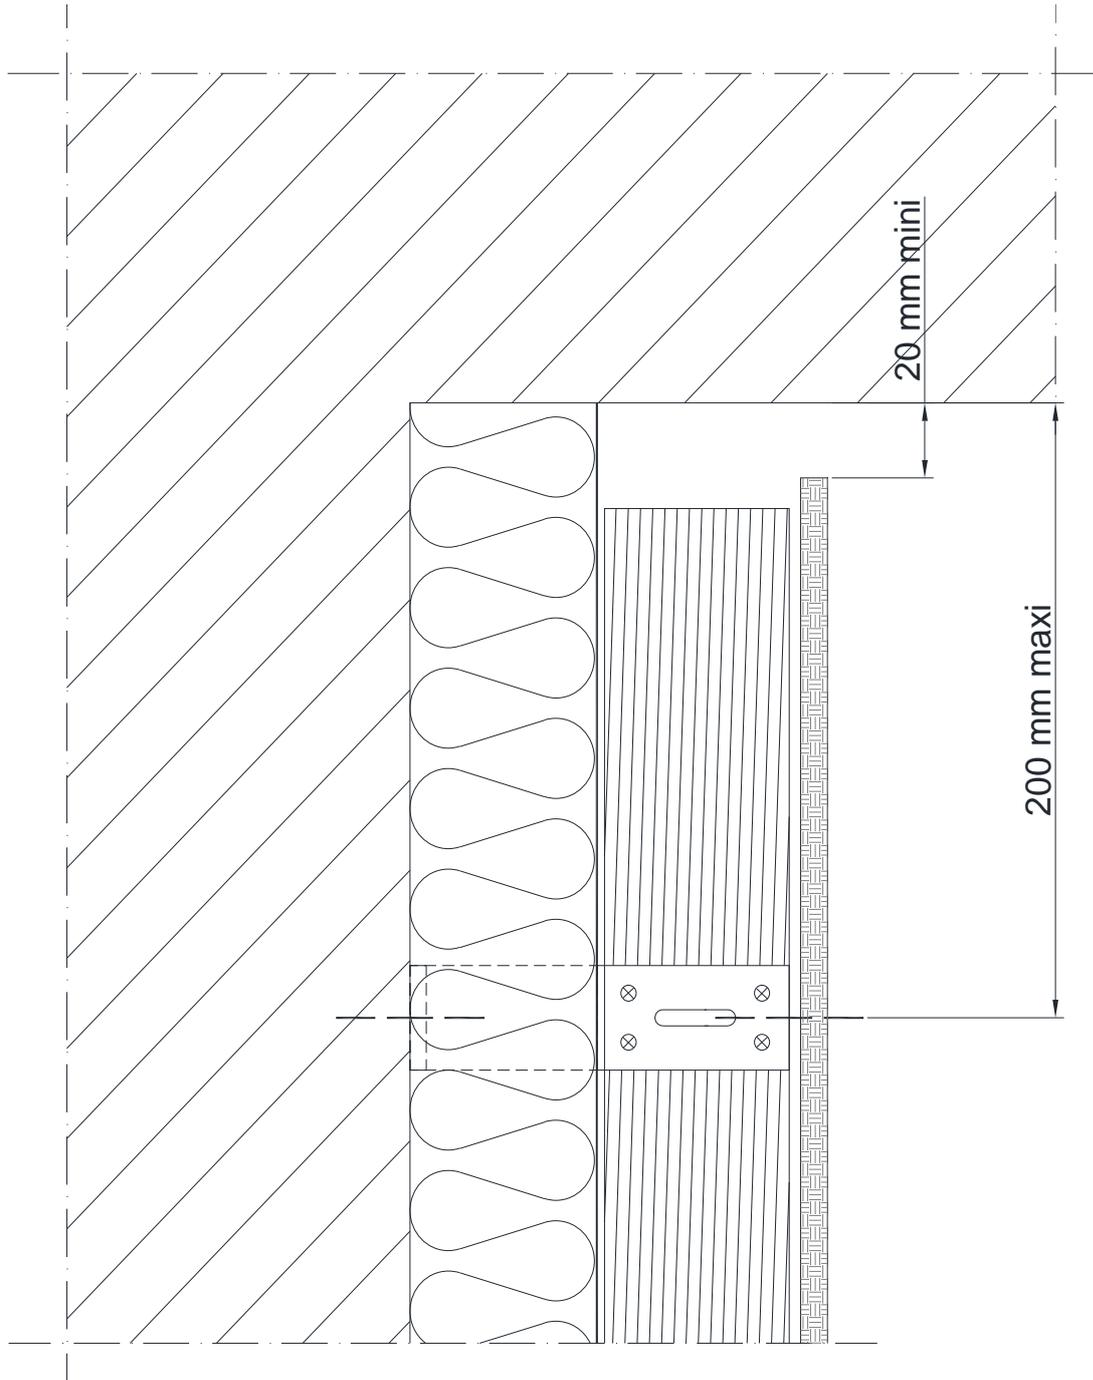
Arrêt sous saillie sans goutte d'eau (Coupe verticale)
